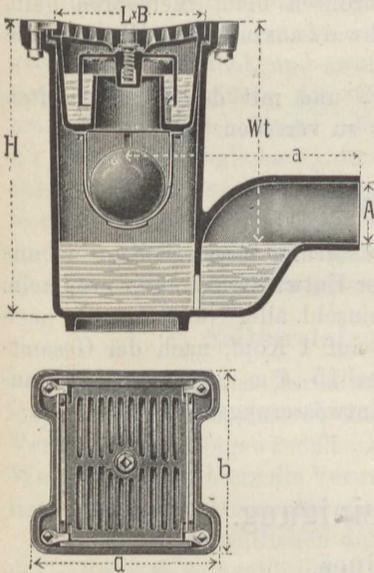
Sinkkasten mit doppeltem Rückstauverschluß (System Oestreicher).
